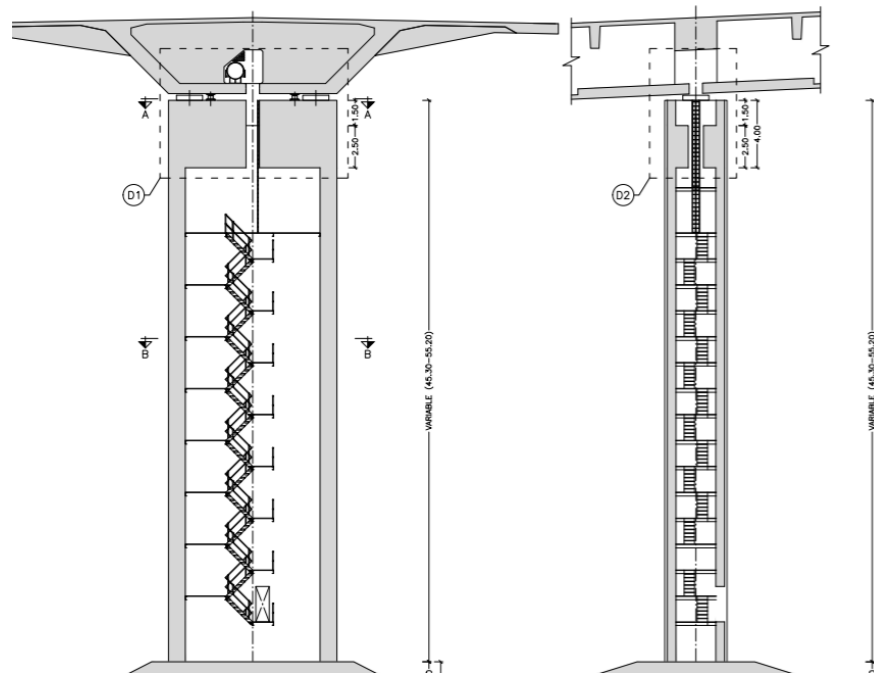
Viaductos de acceso. Alzado pilas P17 y P38
